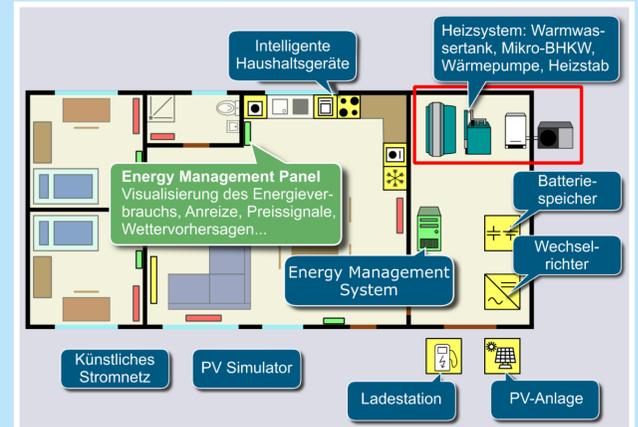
Grundriss Energy Smart Home Lab
